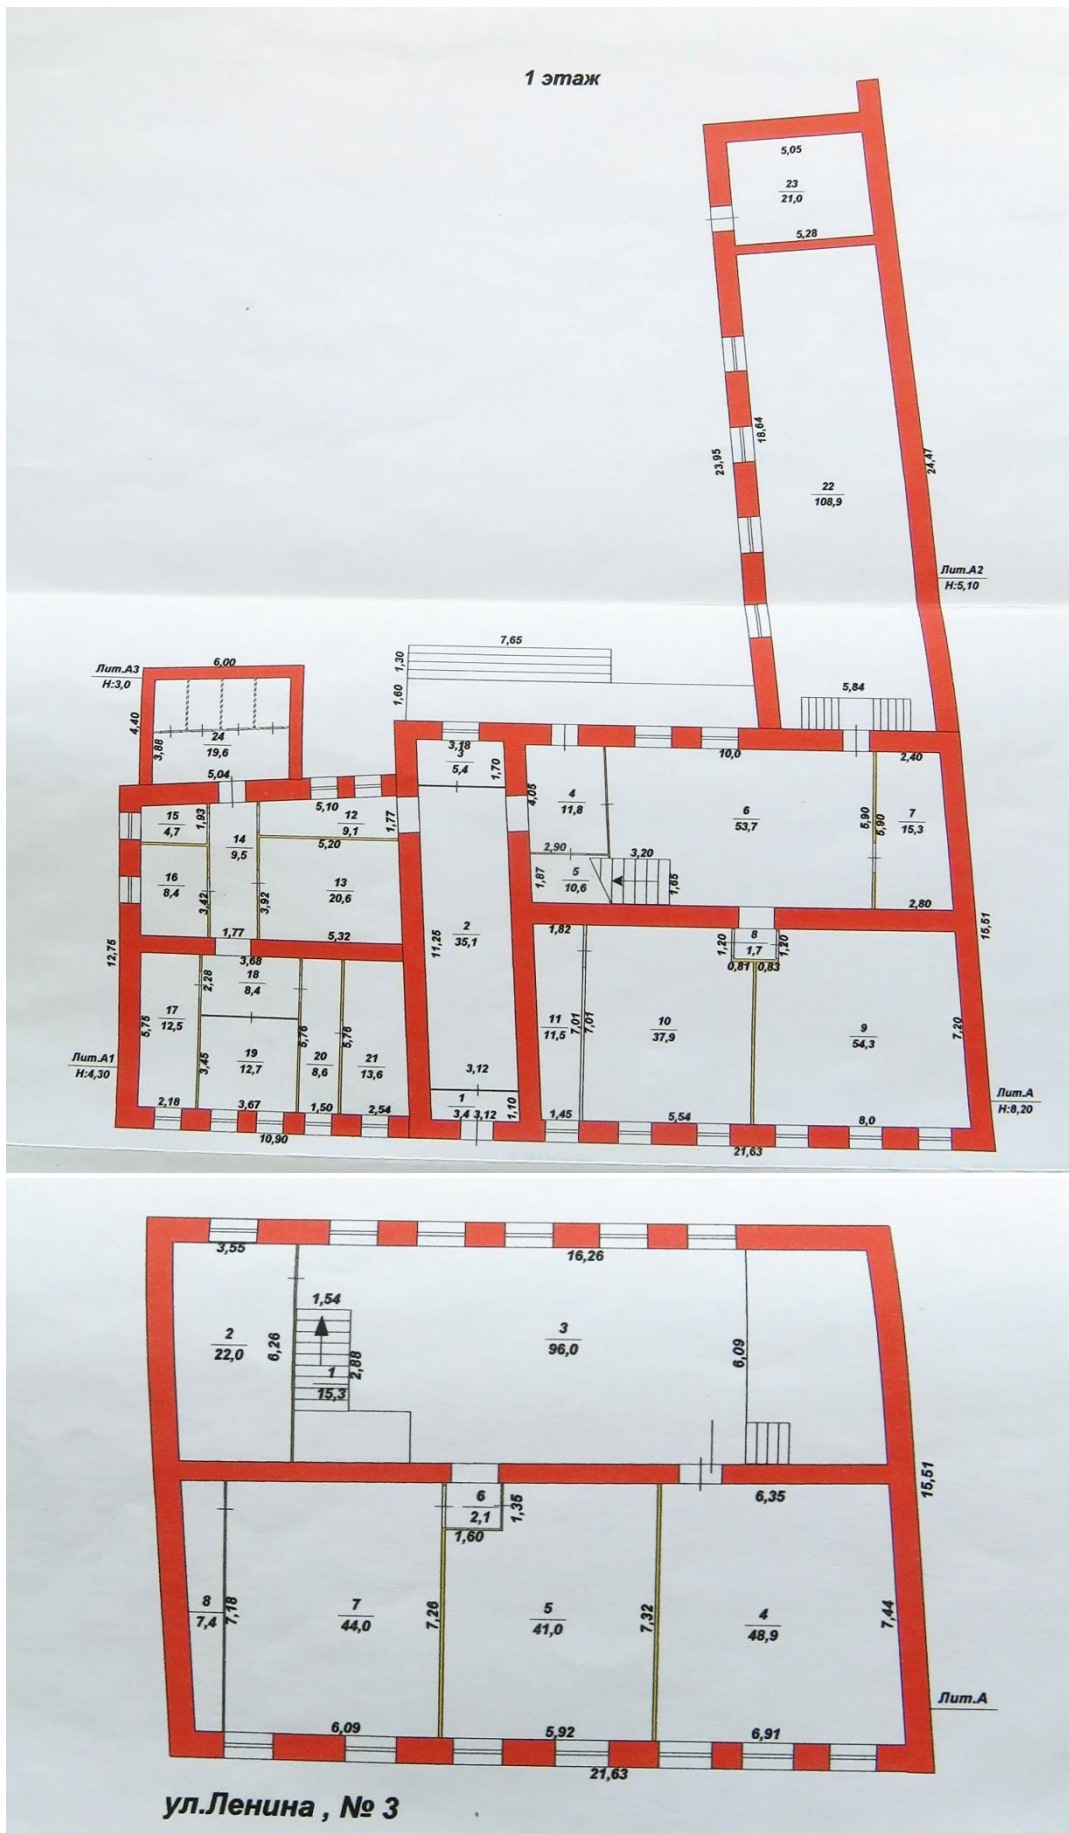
Поэтажный план объекта. План первого и второго этажей.
